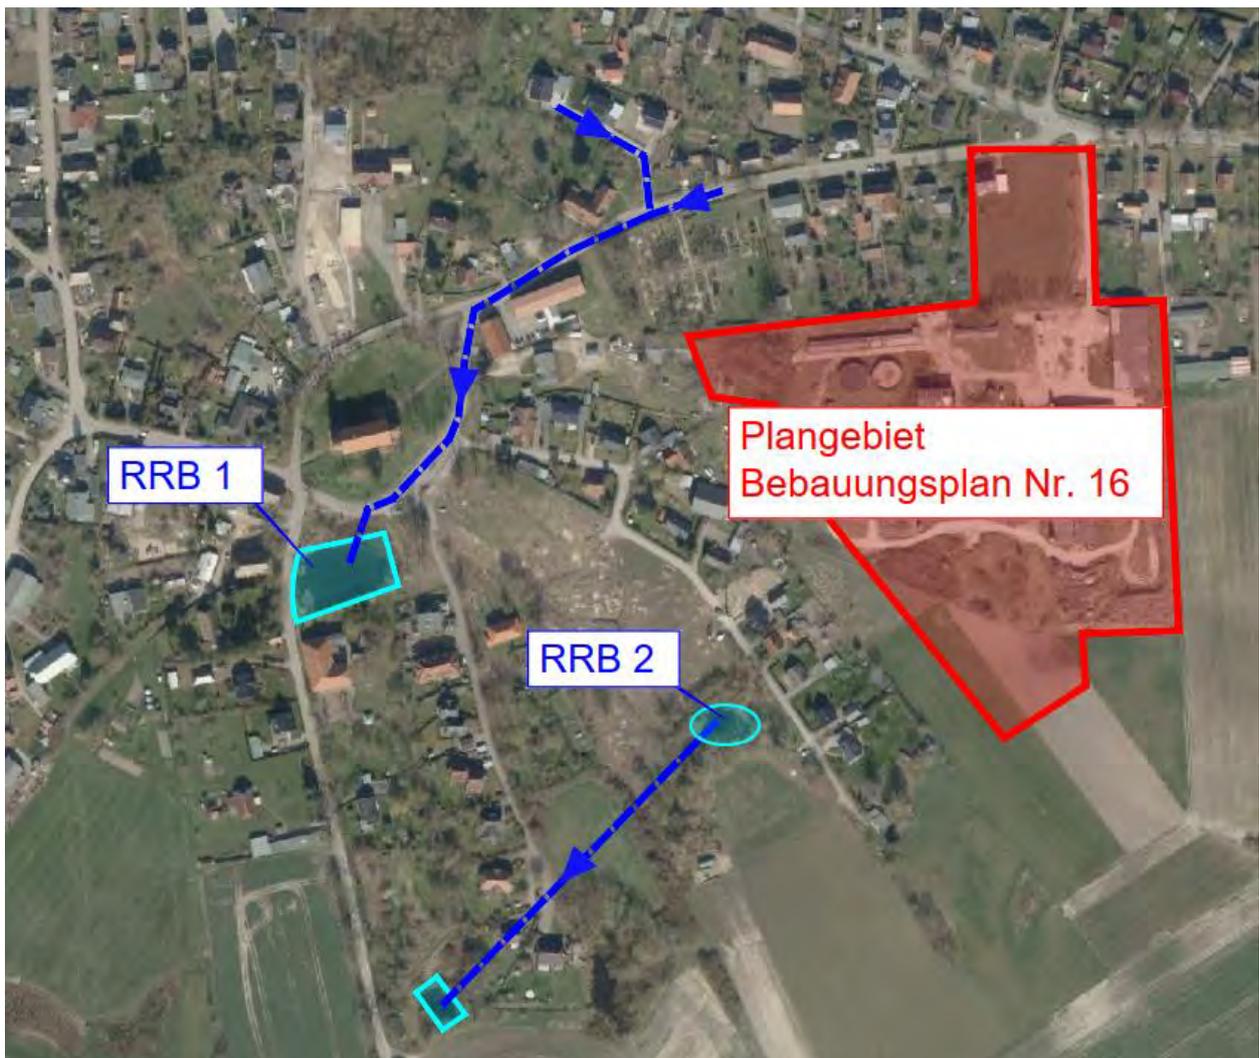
Übersichtslageplan Bestandsituation Entwässerung Ortslage
